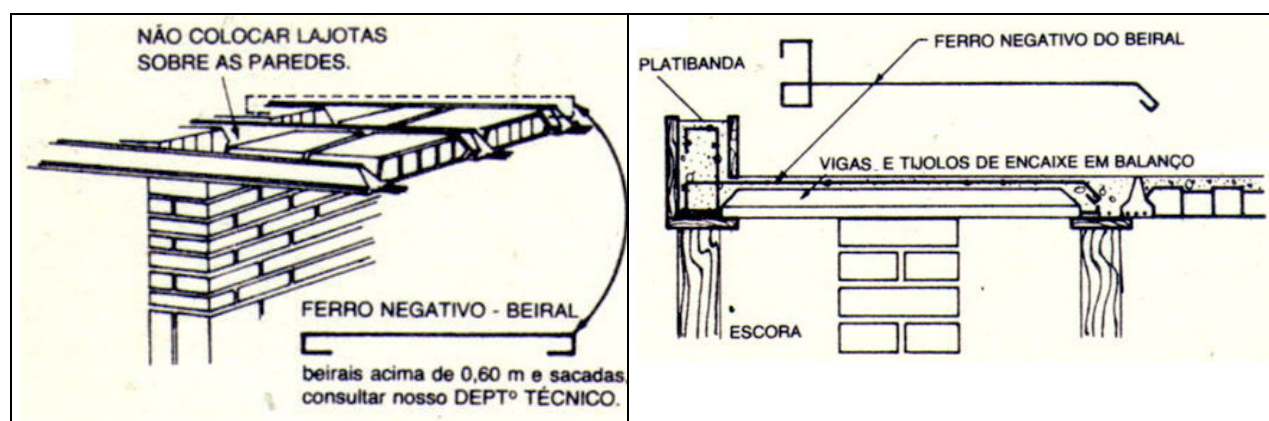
Beiral com a laje pré-fabricada (LAJES ALMEIDA).
